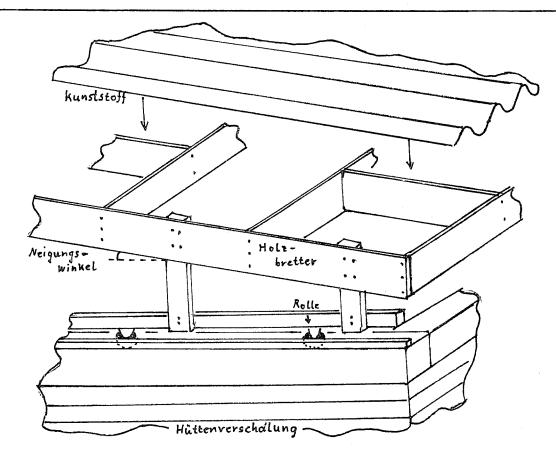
Schematische Darstellung der Dachkonstruktion (Ausschnitt aus Abb. 1)
